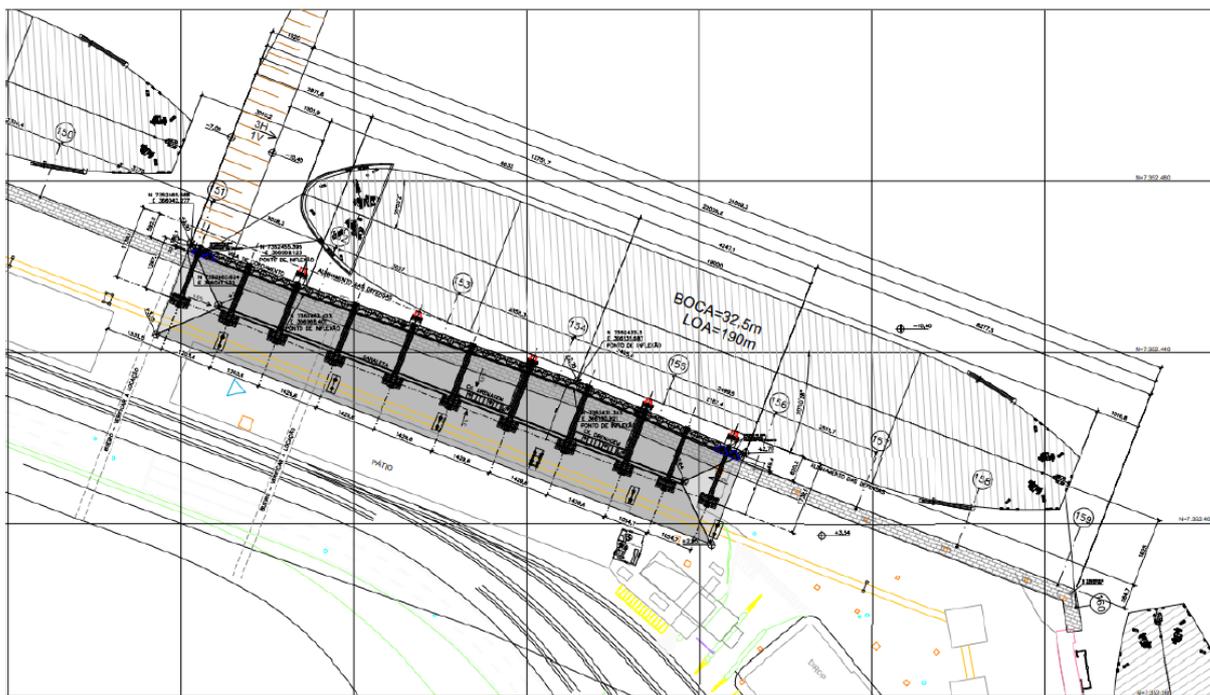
Projeto de Reforço do Trecho do Cais Frontal ao Antigo Armazém 12 - Planta
